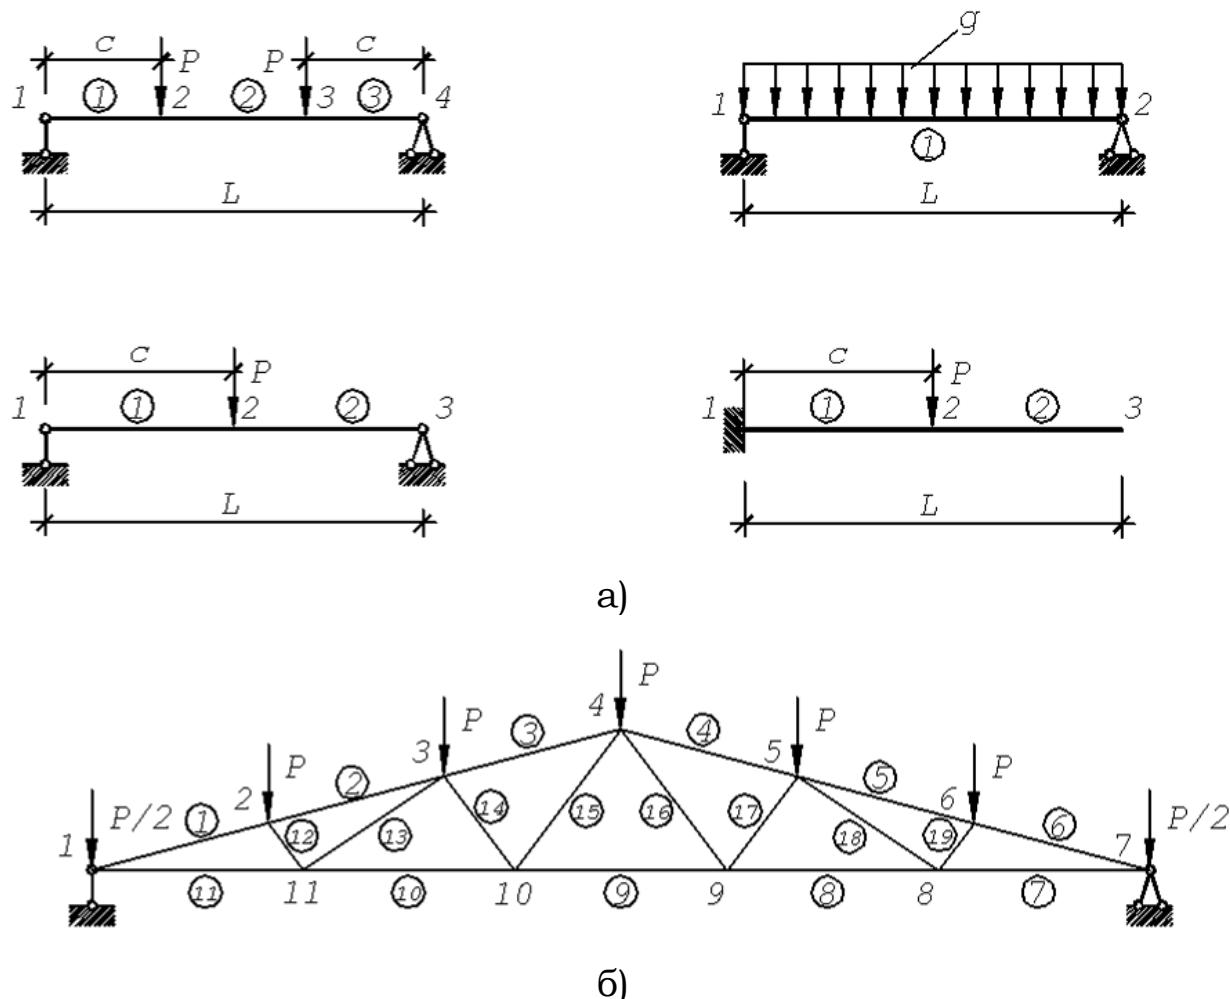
Приклади нумерування вузлів та елементів (стрижнів) розрахункових схем: а) балки; б) ферми.
